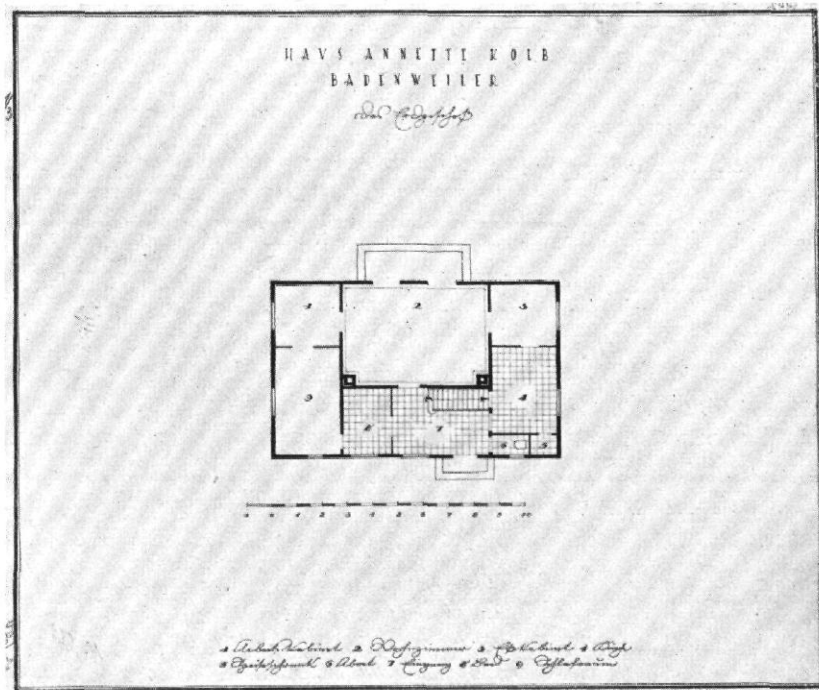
| Haus Annette Kolb, Badenweiler | Grundriß des Erdgeschosses, Maßstab 1 : 300
